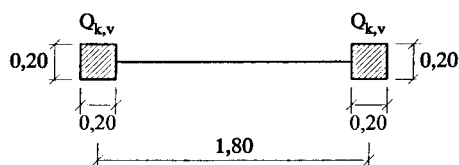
Configuração em planta da aplicação de $Q_{k,v}$ em garagens e acesso de automóveis.
